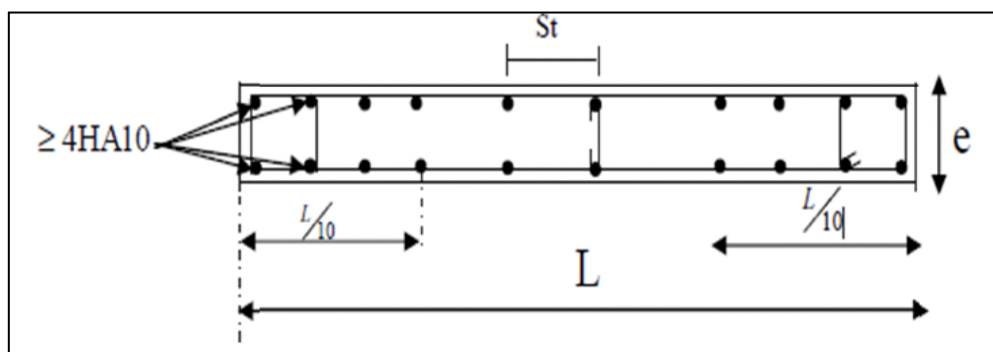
Disposition des armatures verticales dans les voiles.
